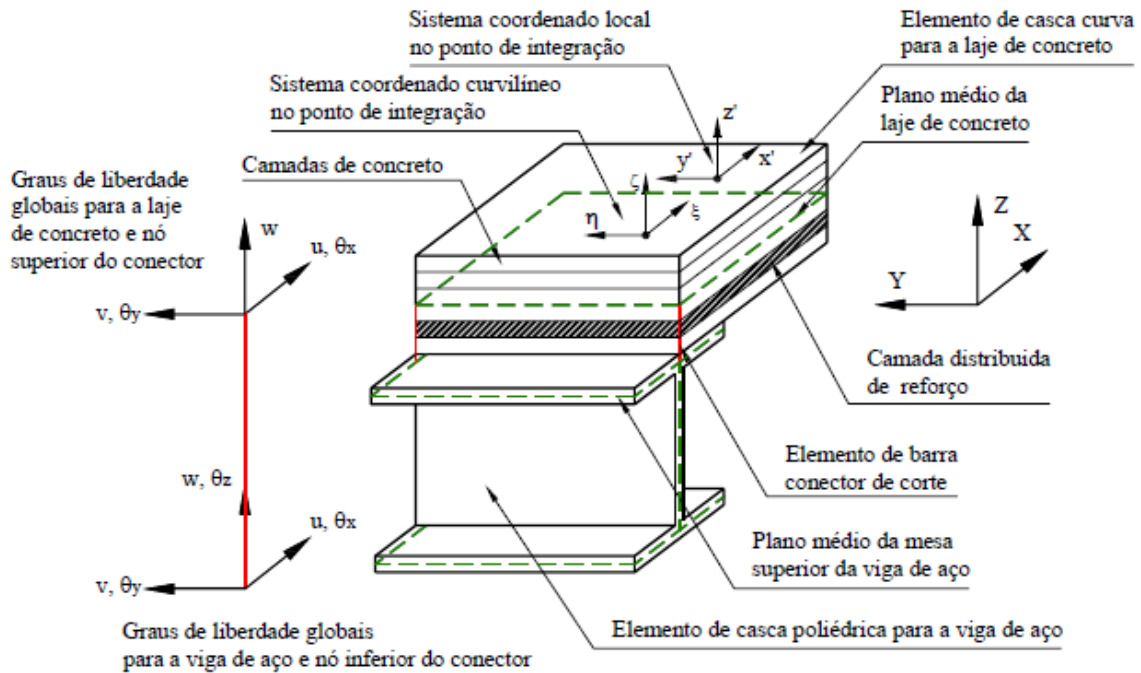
Montagem do modelo para elemento de viga mista - Fonte: Tamayo et al. (2011).
